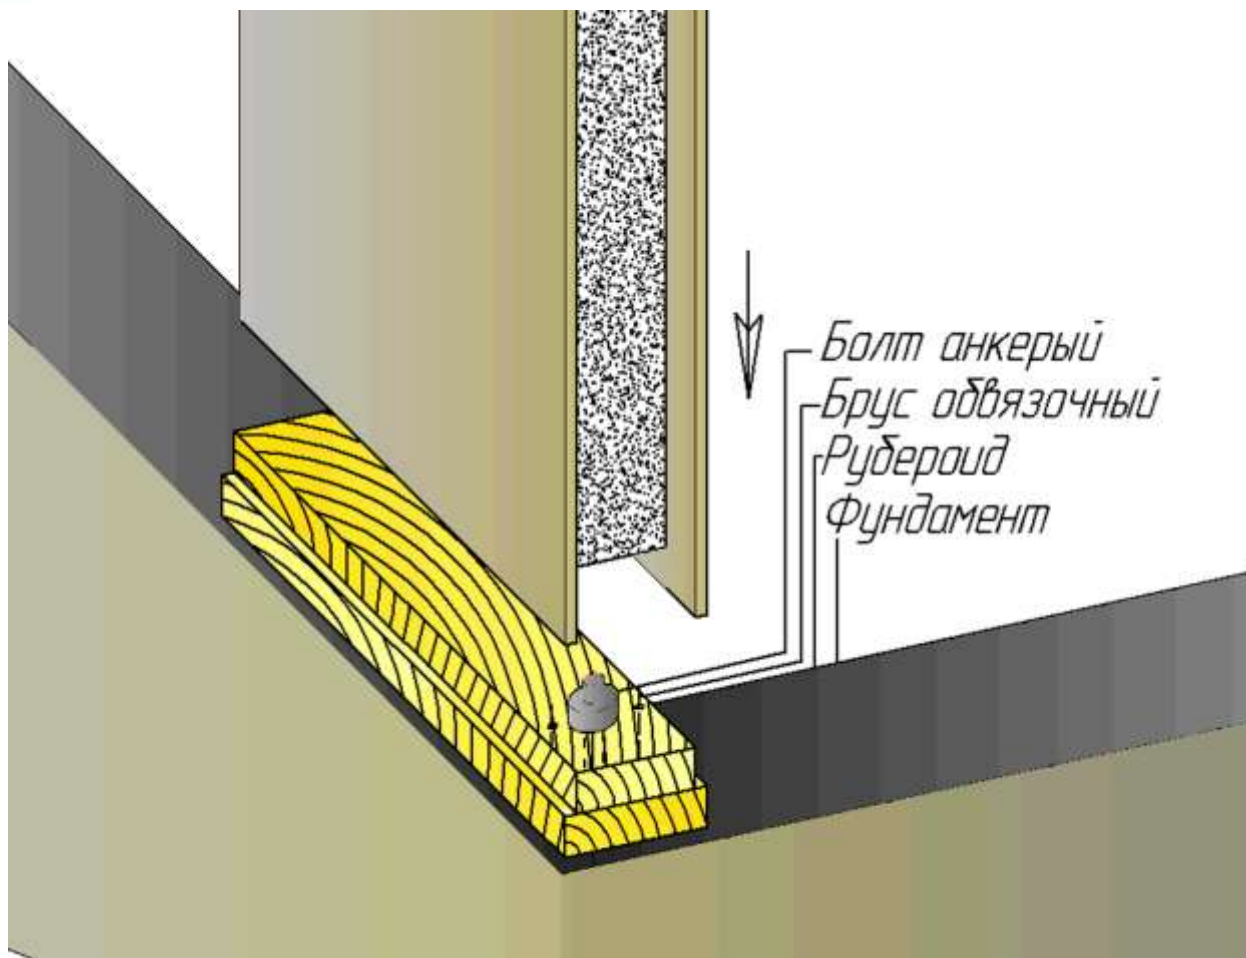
б. Соединение стеновой панели с фундаментом. Вариант №1
